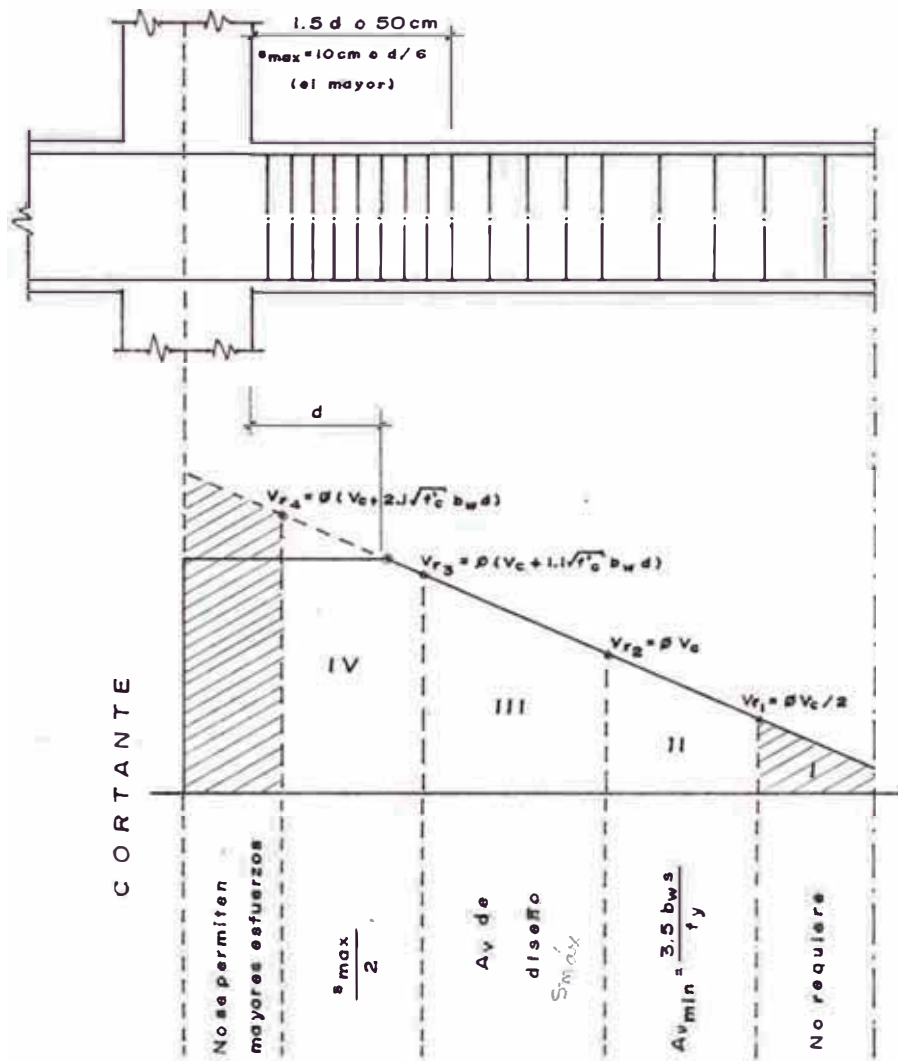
Requisitos de detallado de refuerzo por corte en vigas
